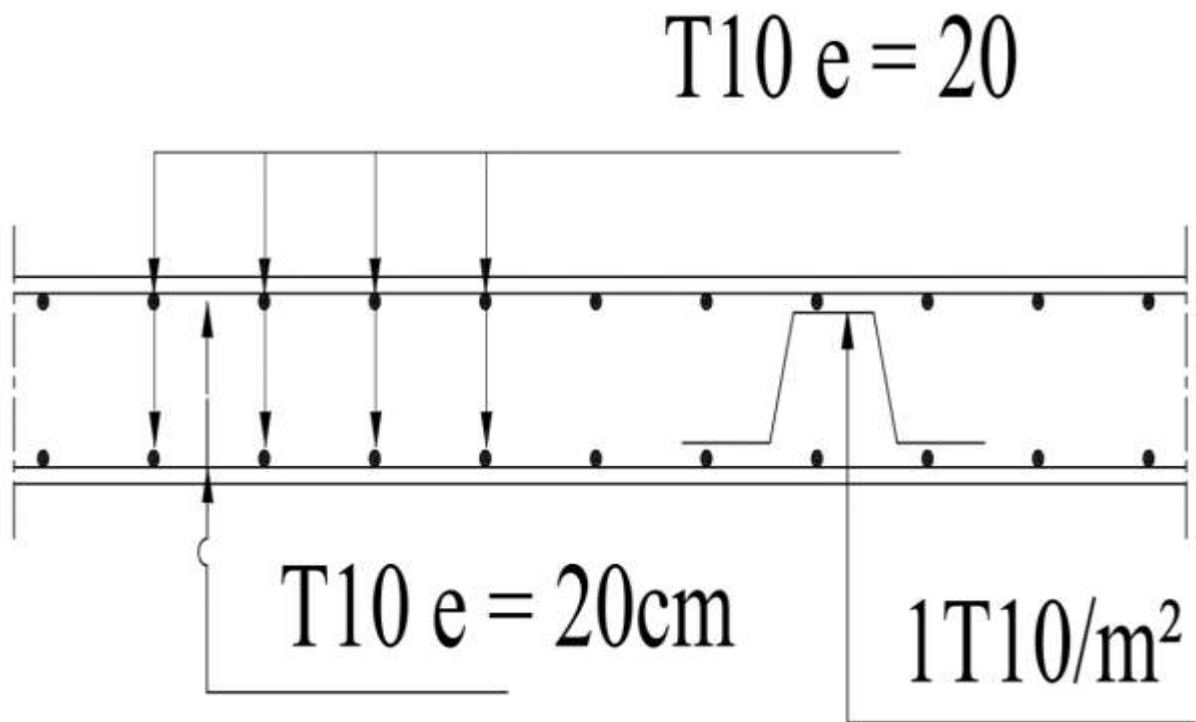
Schéma de ferrailage de la dalle machine d'ascenseur.
